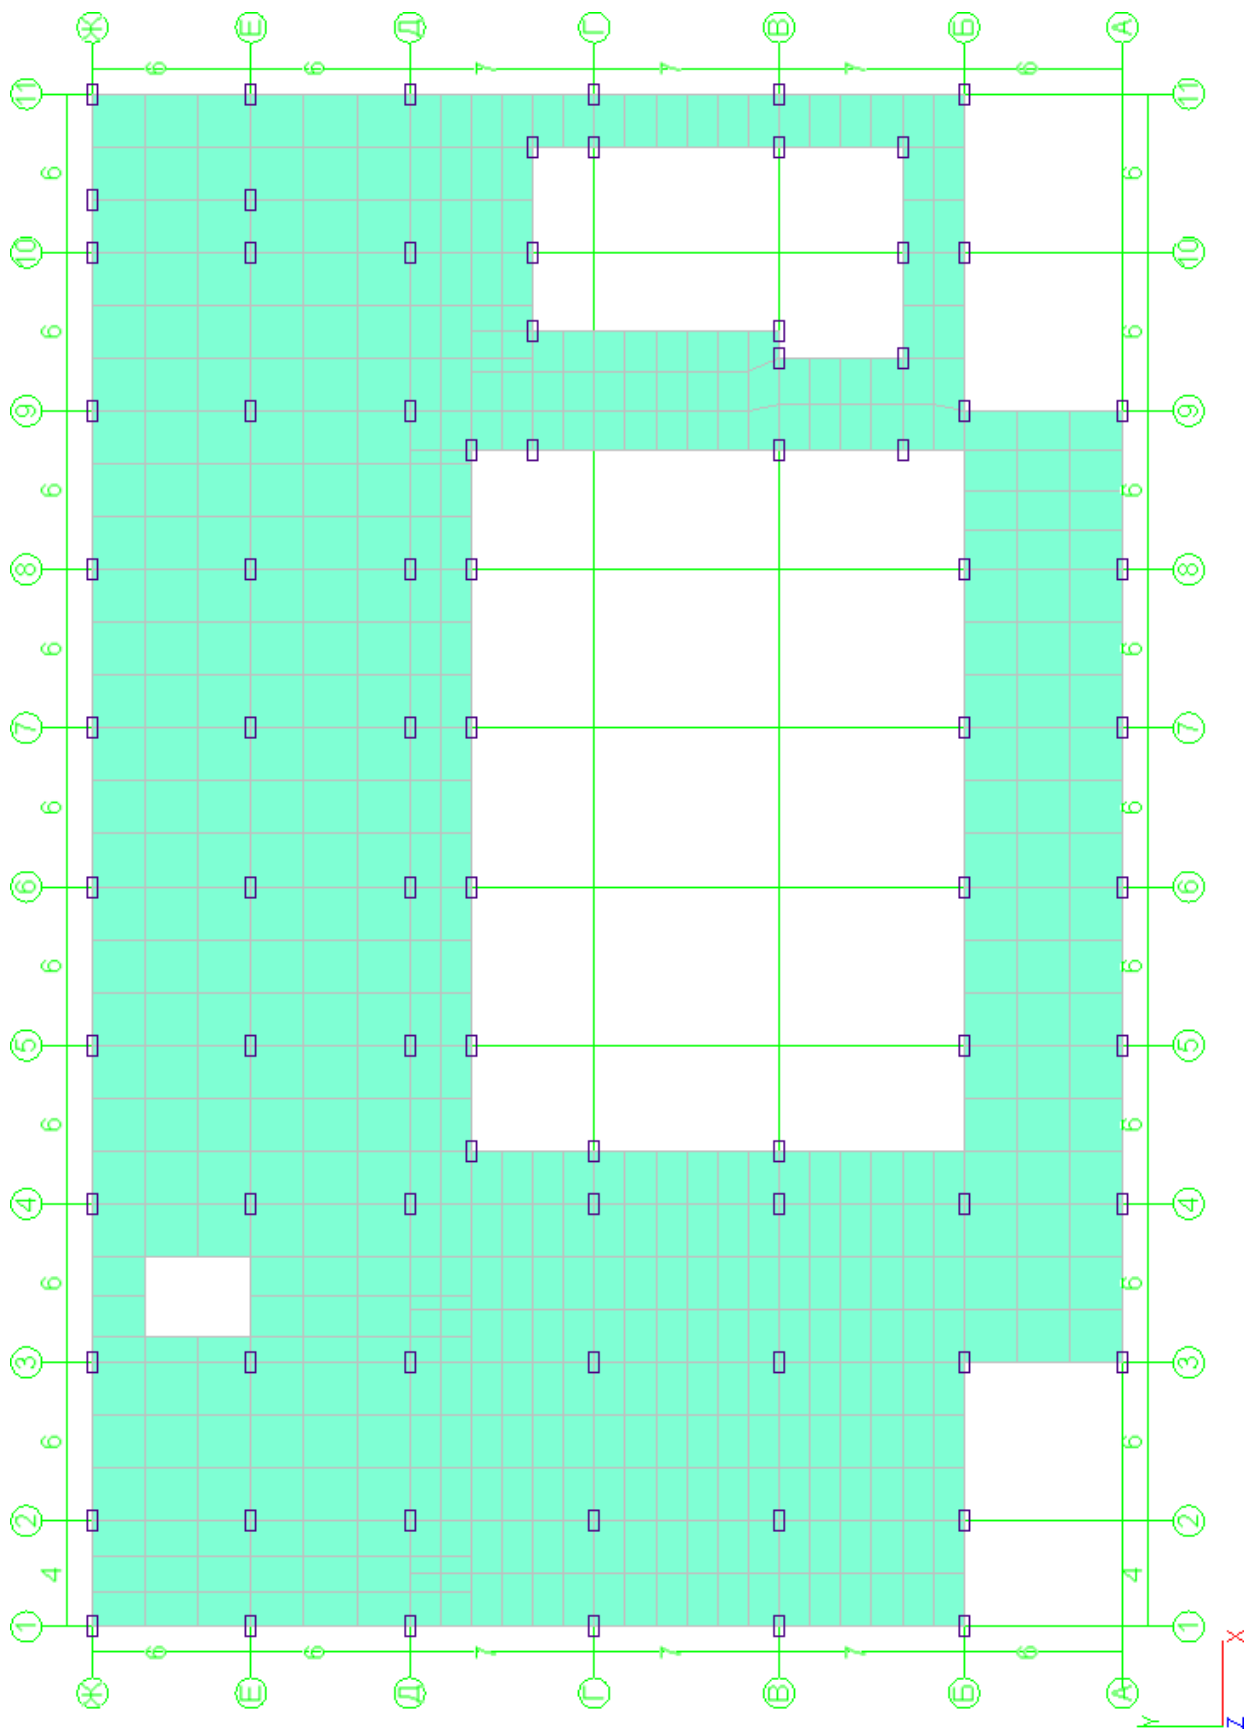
Расчетная схема монолитной плиты перекрытия
